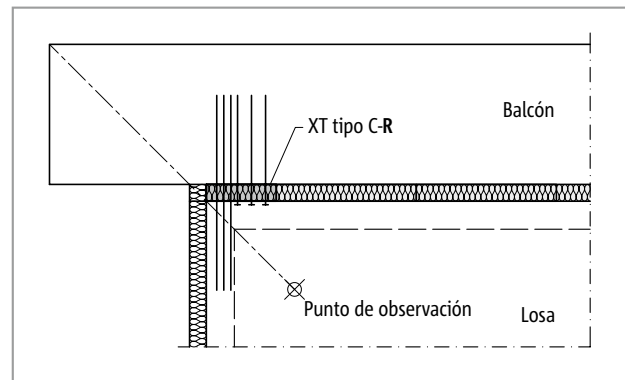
Schöck Isokorb® XT tipo C: Balcón voladizo sobre la esquina del edificio (utilización de XT tipo C-R)
